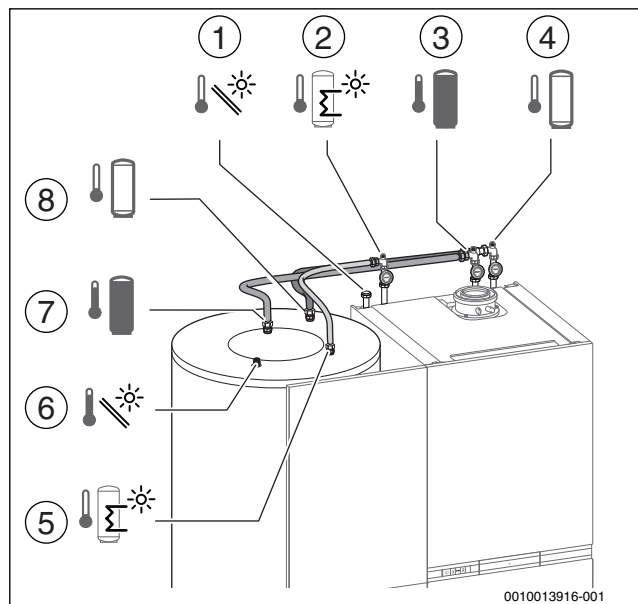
Hydraulische Anschlüsse: Pufferspeicher, Solarkollektoren
